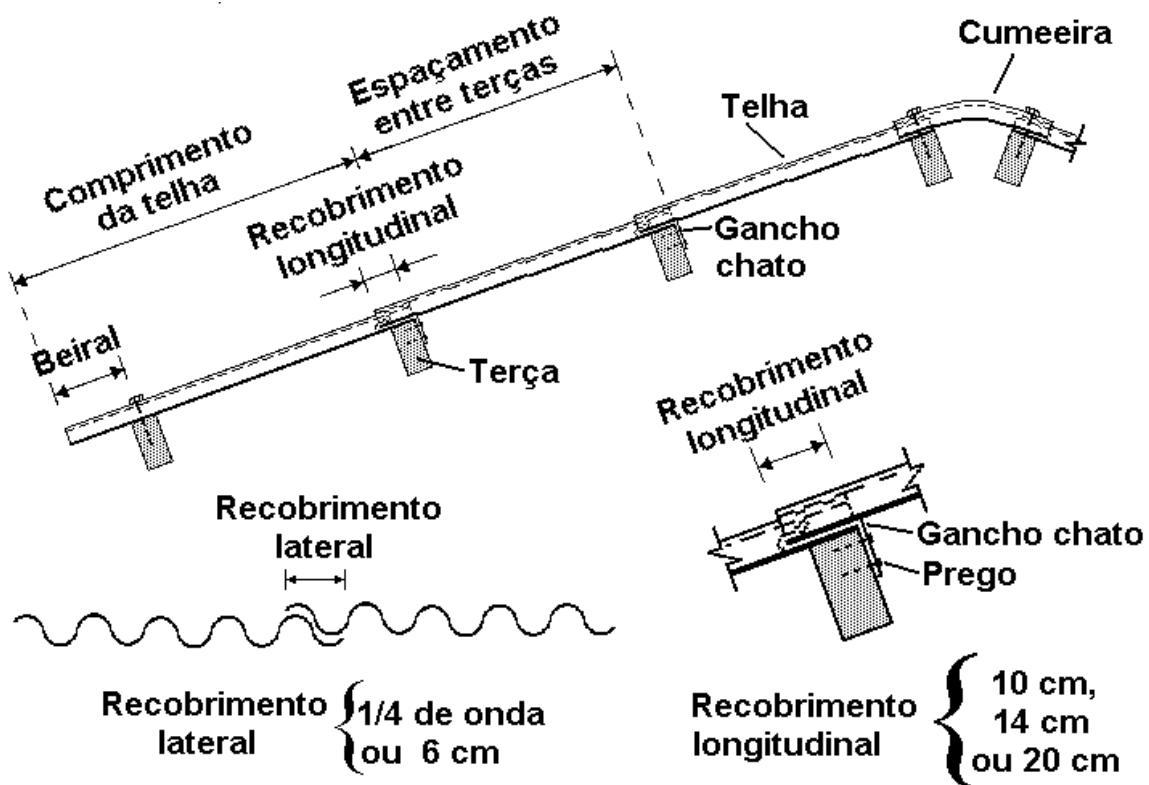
Trama de um telhado convencional com telhas de fibrocimento
